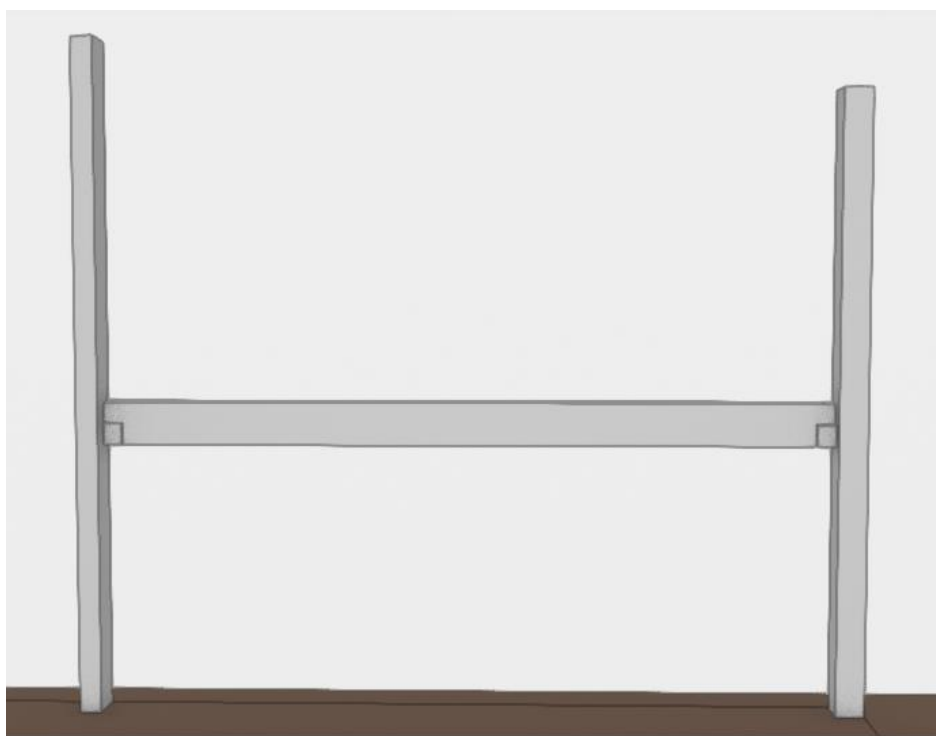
Pilar pré-fabricado de concreto com consolo para apoiar viga gerber.
